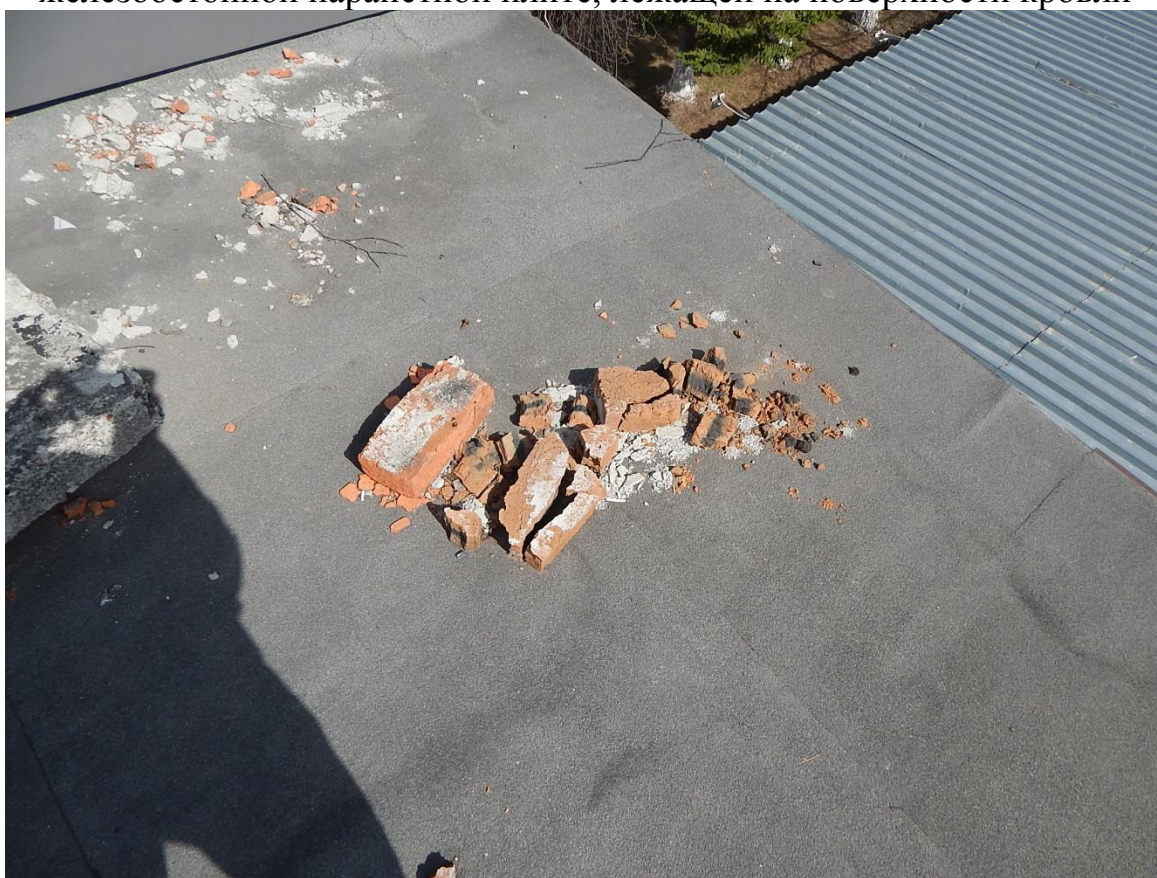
Наличие строительного мусора на поверхности кровли
